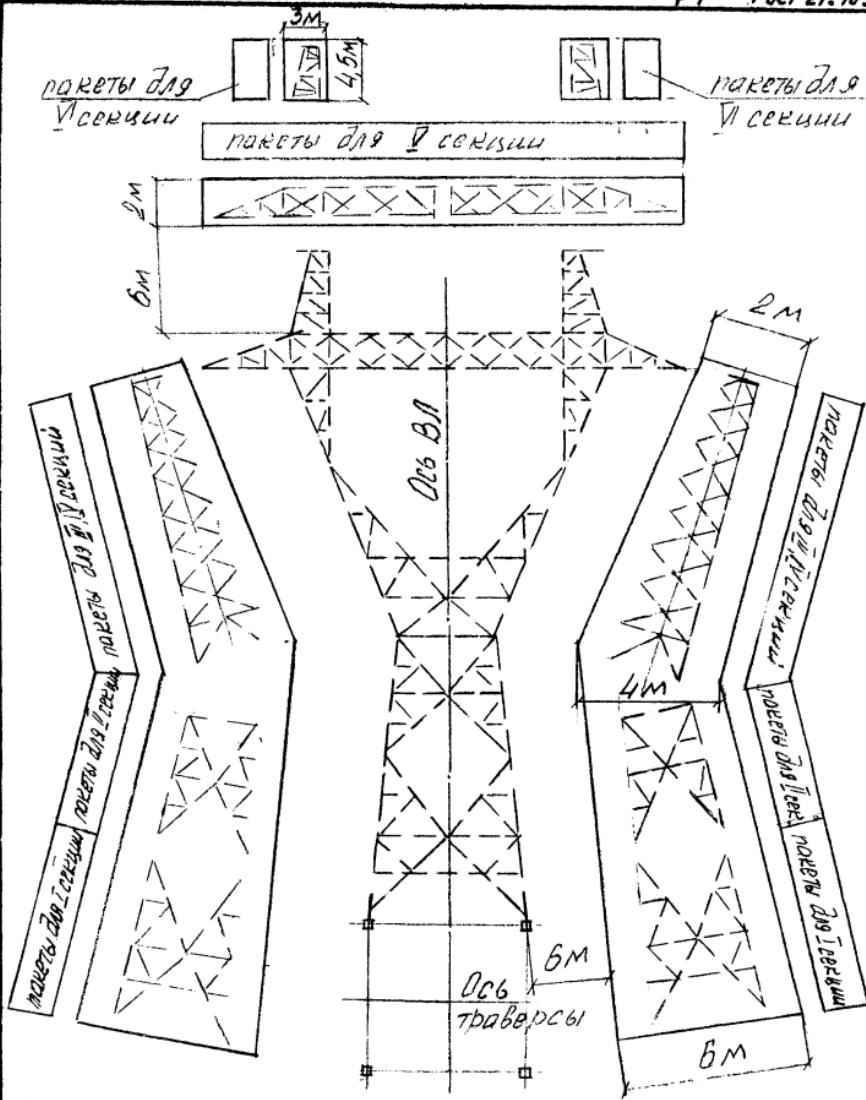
План площадки для сборки опоры Р1, Р2
